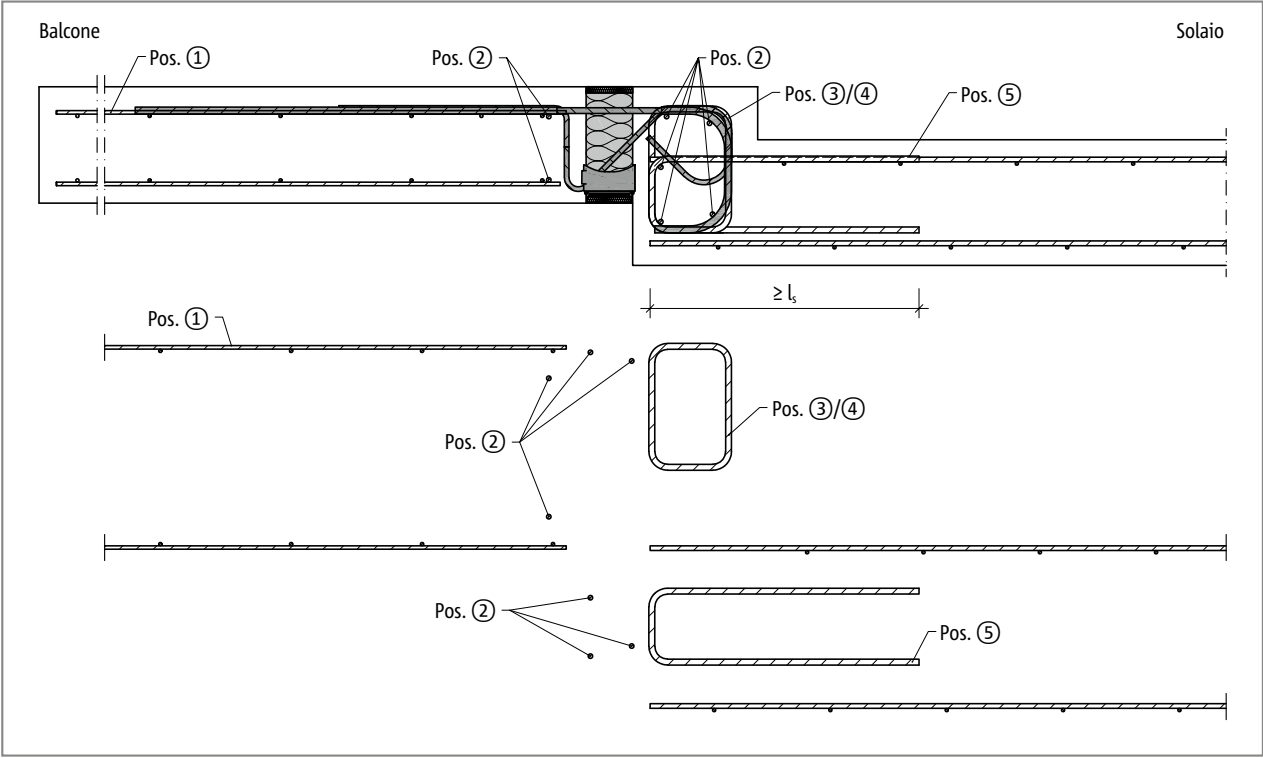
Schöck Isokorb® T tipo KL-O: armatura in opera
